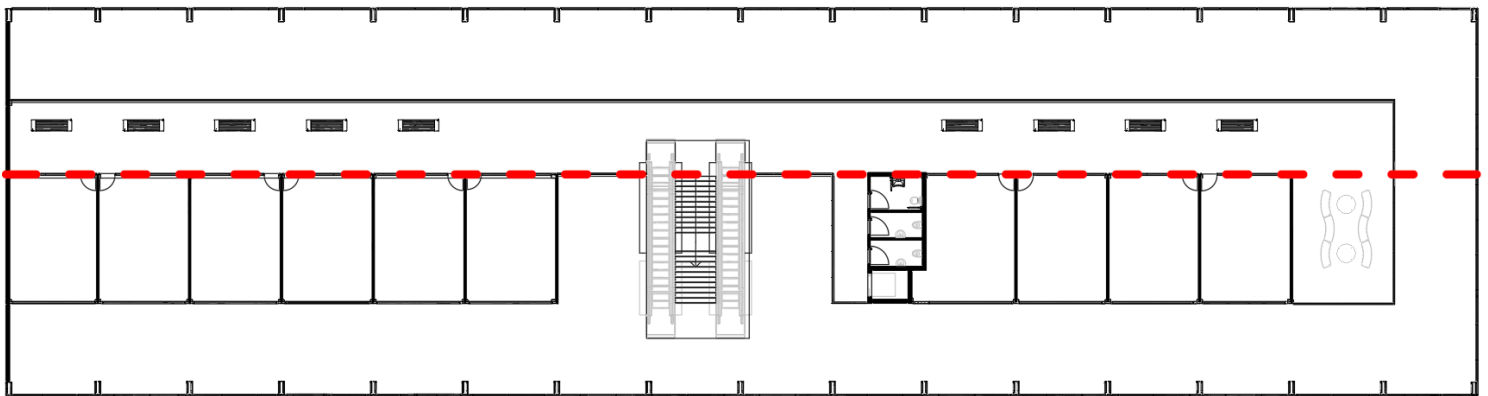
Ubicación de las columnas de apoyo de las vigas metálicas
